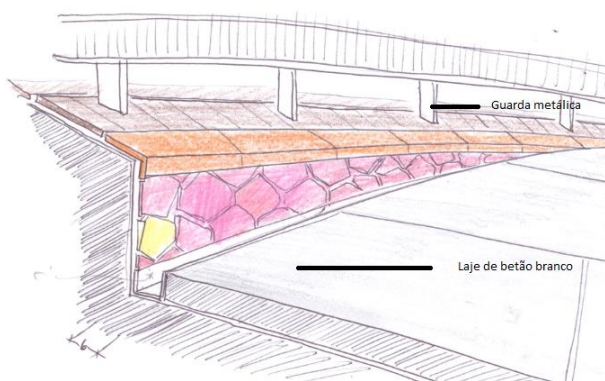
Encontro do lajeado de betão branco na cobertura piso 3.
